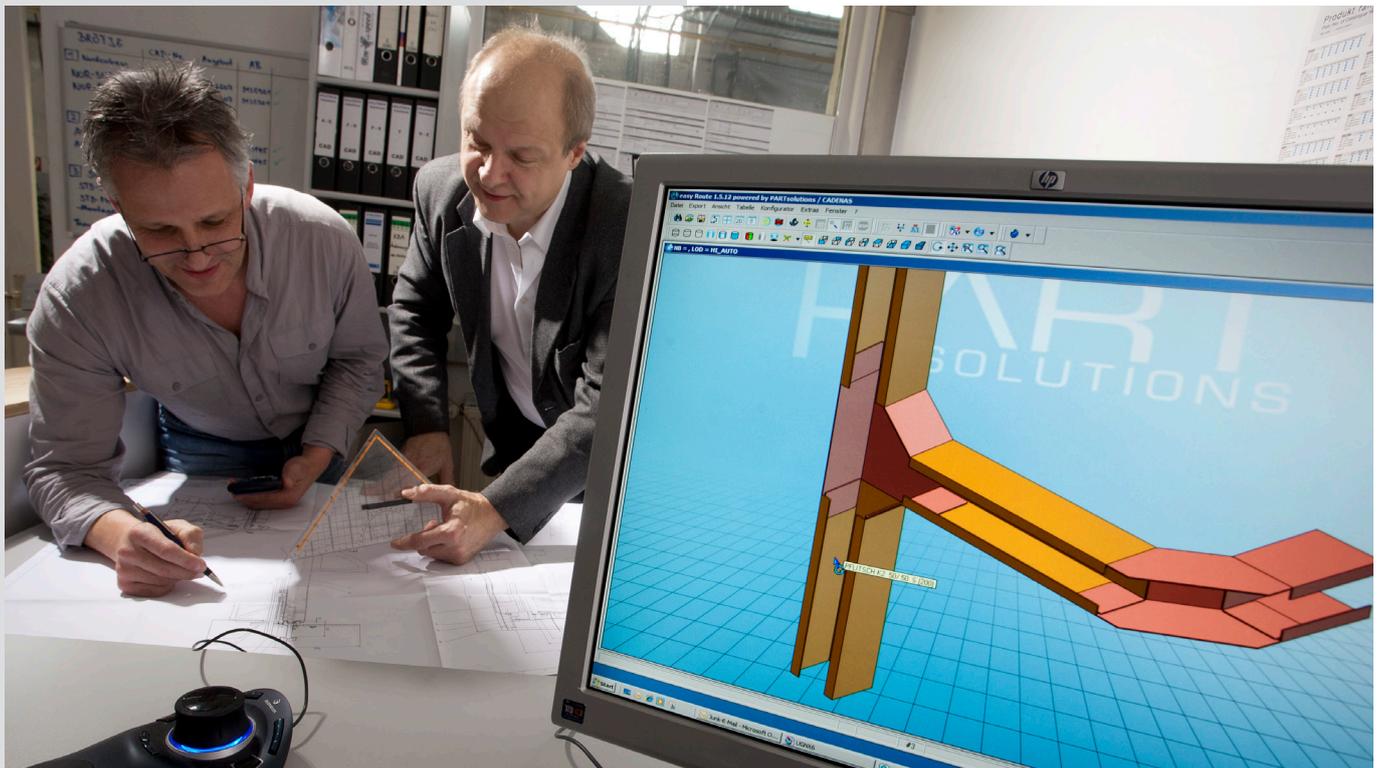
Mit dem CAD-Tool easyRoute sind Konfigurationen schnell, sicher und transparent für die jeweilige Einbausituation konfigurierbar.
